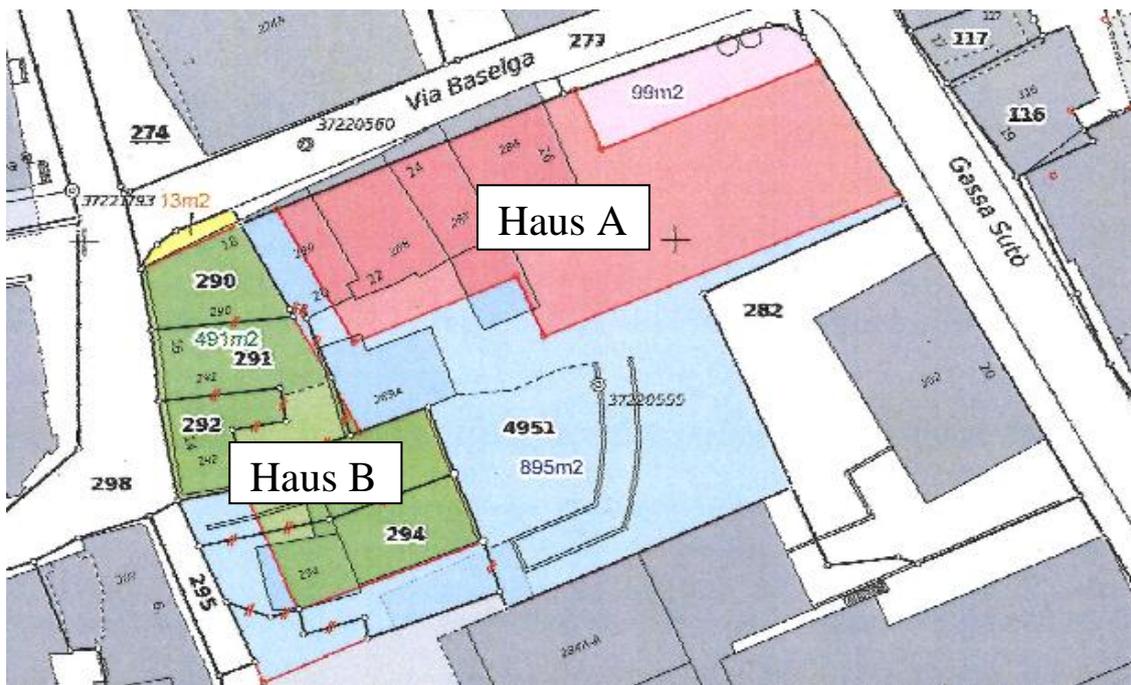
Baubereich Haus A (rot) und Haus B (grün)
